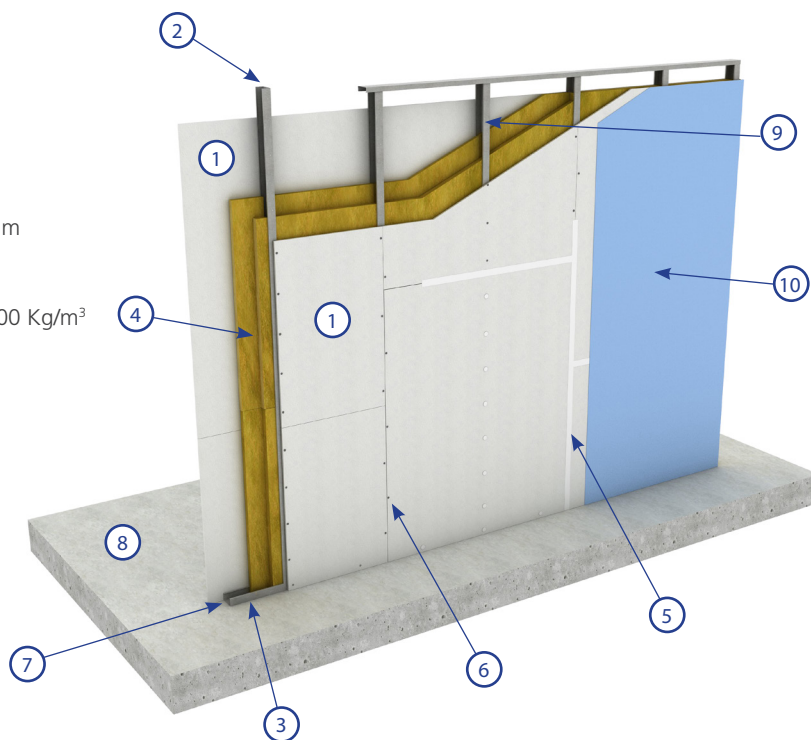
Tabiquería PassiveTec® - Montante galvanizado
